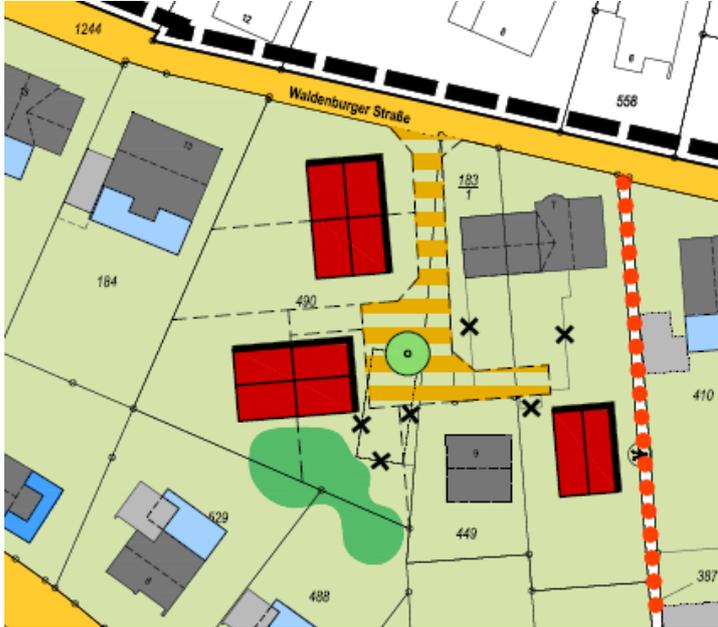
Ausschnitt Detailbereiche-Ost „südlich Waldenburger Straße“, Variante 1 „städtebauliche Ausrichtung auf baulichen Bestand“ (Stand Mai 2015) – genordet, ohne Maßstab
